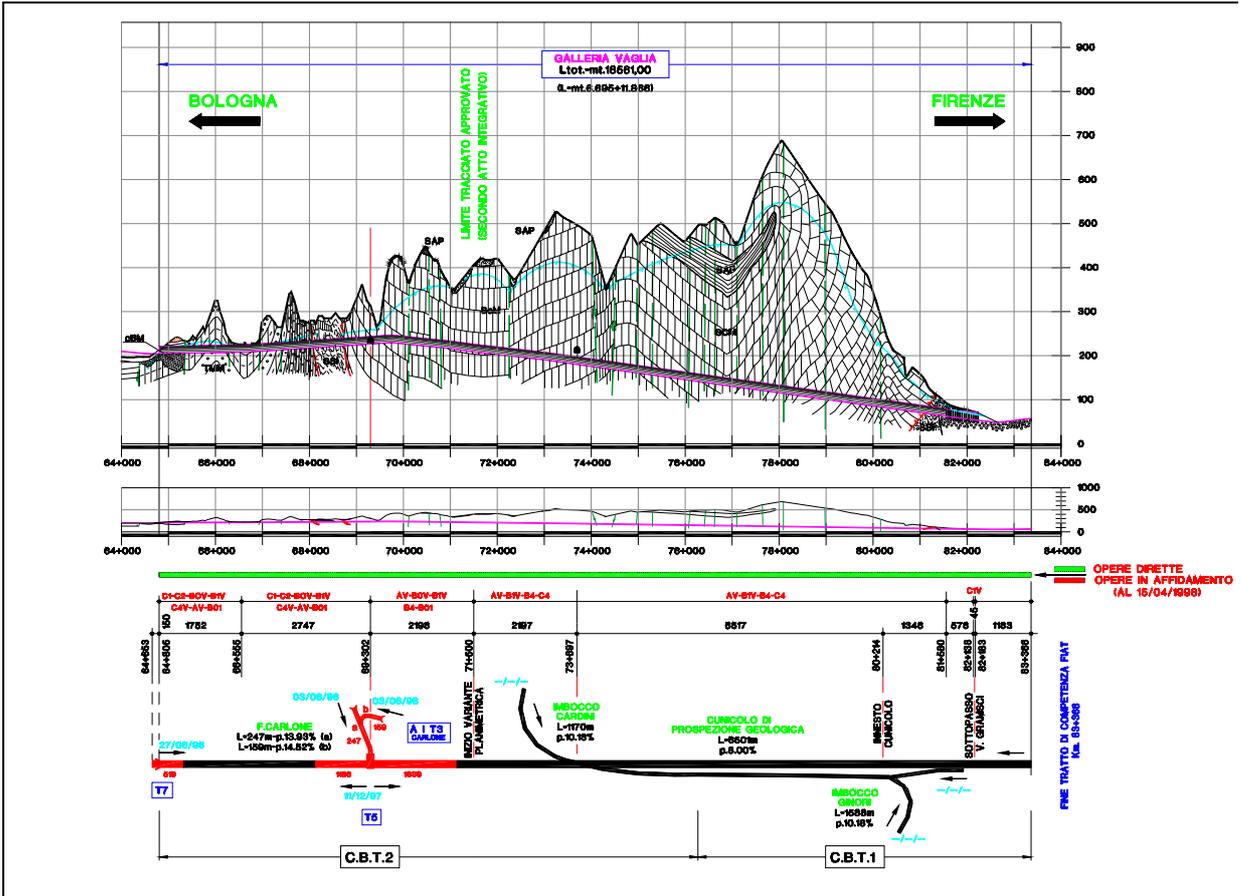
Andamento planimetrico della galleria di servizio “Ginori” e profilo geologico della
